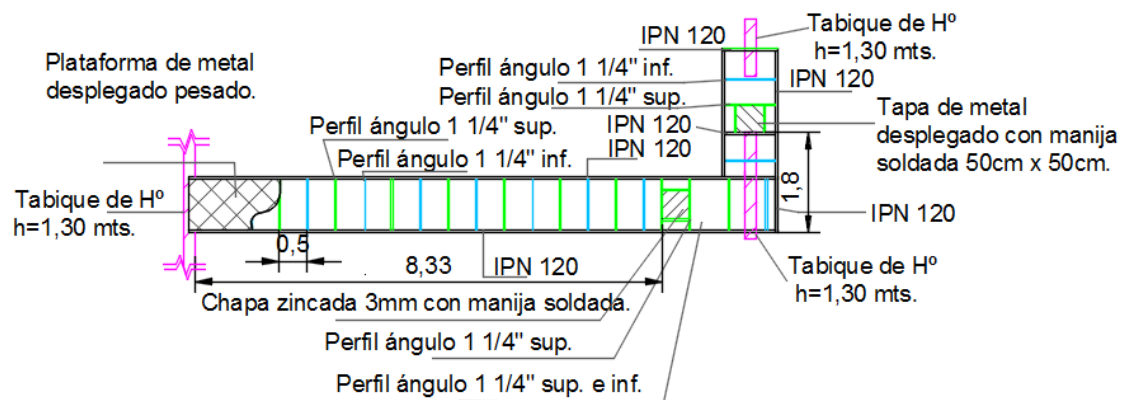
Detalle de Pasarela de mantenimiento – Planta.
